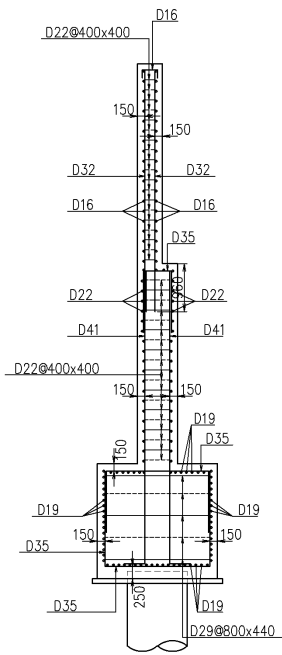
(1) 免震重要棟遮蔽壁の概略配筋図 (単位: mm)
